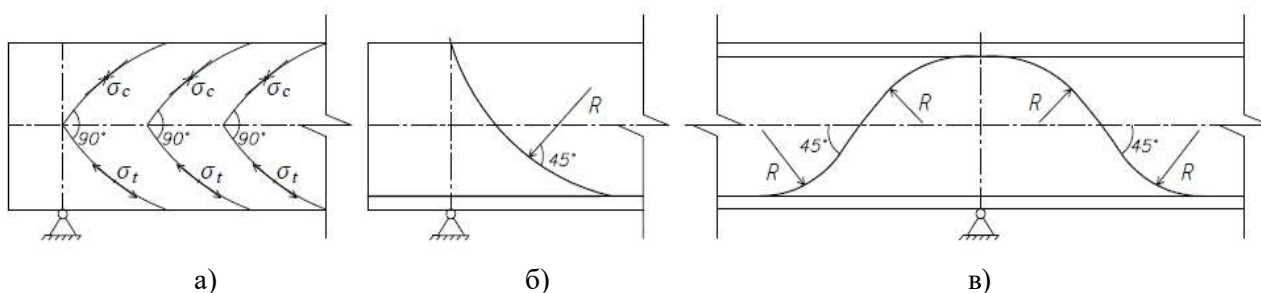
Отгибы стержневой композитной арматуры в балках: а) траектории главных напряжений в балке, б) отгибы стержней арматуры на опоре однопролетной балки, в) отгибы стержневой арматуры на промежуточной опоре многопролетной балки
